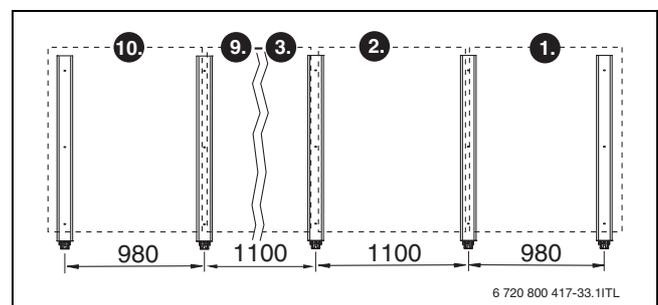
> 3 senkrechte Kollektoren (Maße in mm)
